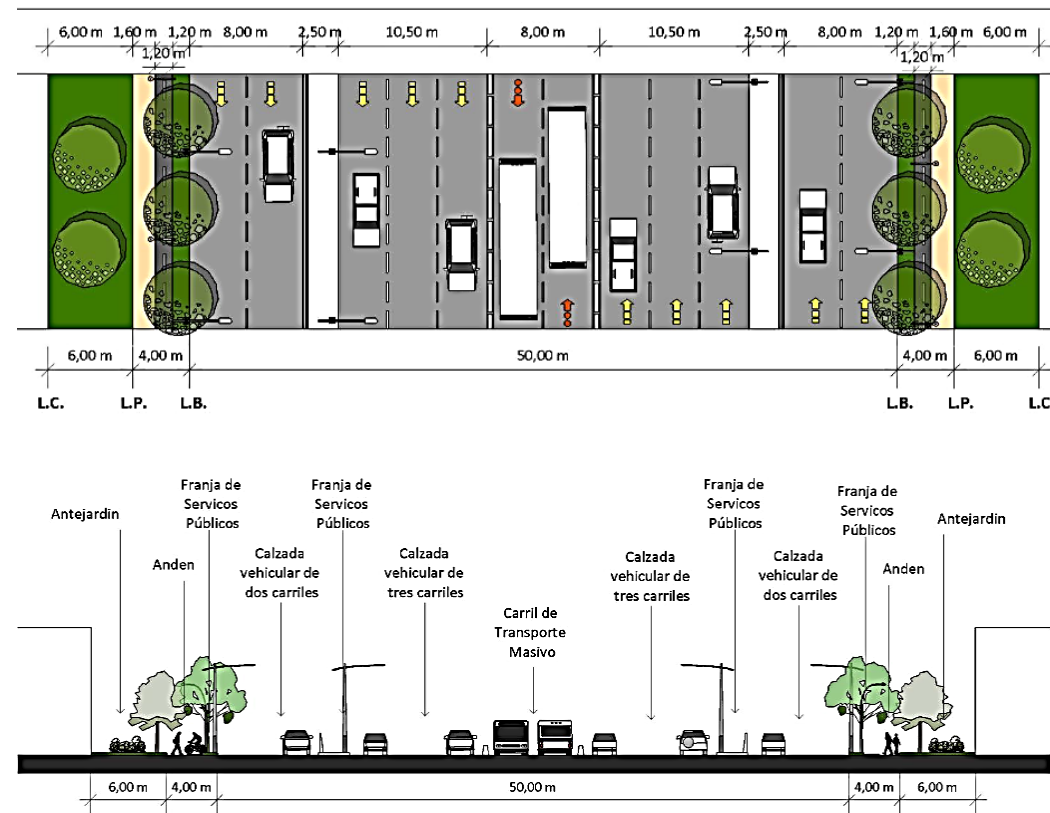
Planta y Perfil propuesto para la ampliación de la Carrera 38. Fuente: Revisión Plan de Ordenamiento Territorial 2012.
